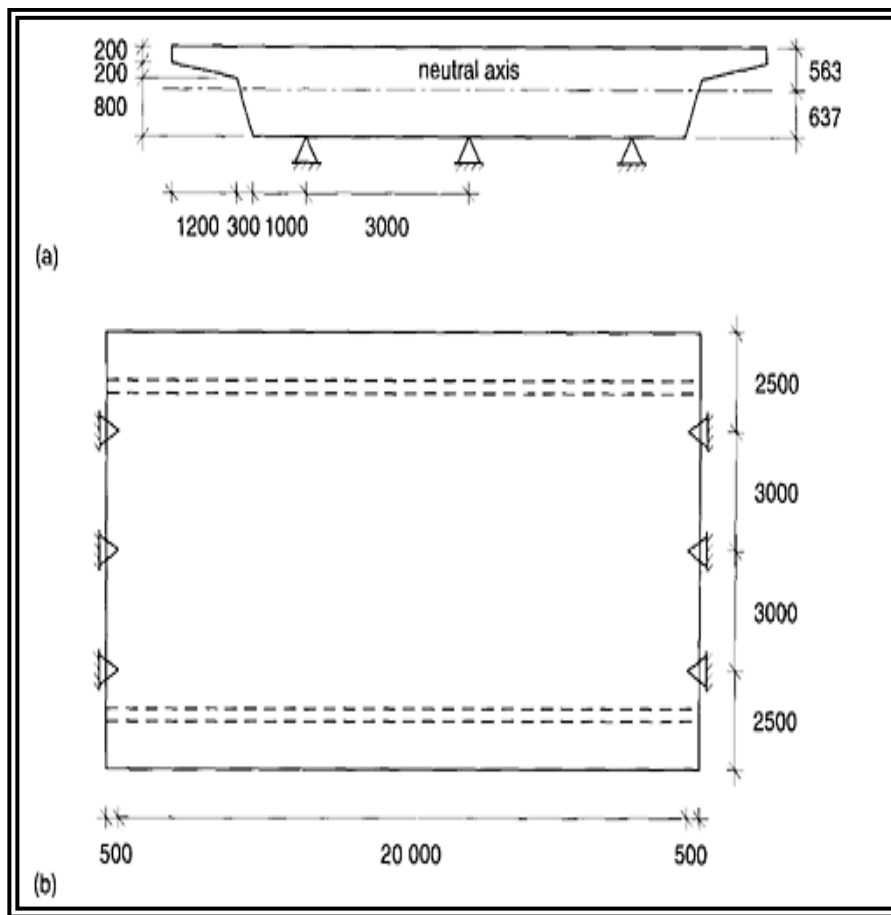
162 Tablero de puente con voladizo: (a) Sección, (b) Planta ¹⁷⁶.
